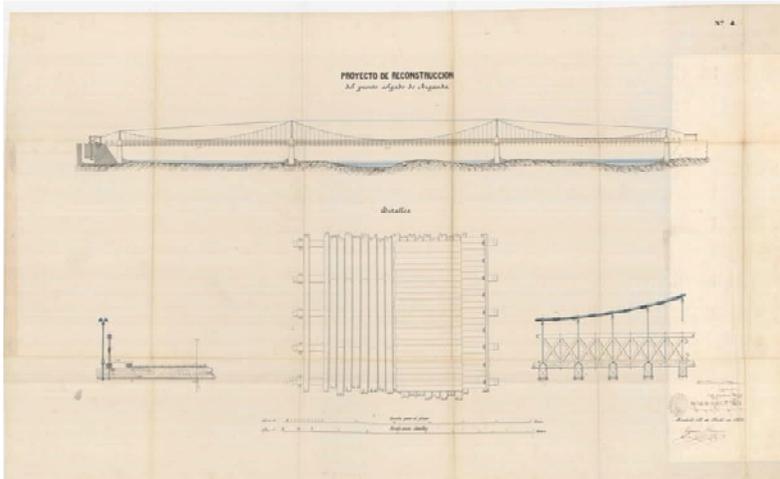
[España] Ministerio de Cultura y Deporte. Archivo General de la Administración, Signatura 24-02469, Plano nº 4 de detalles del tablero y vigas de madera colocadas por Real Orden de 27 de mayo de 1859 (Ingeniero Eugenio Barrón, Madrid, 10 de julio de 1859).
